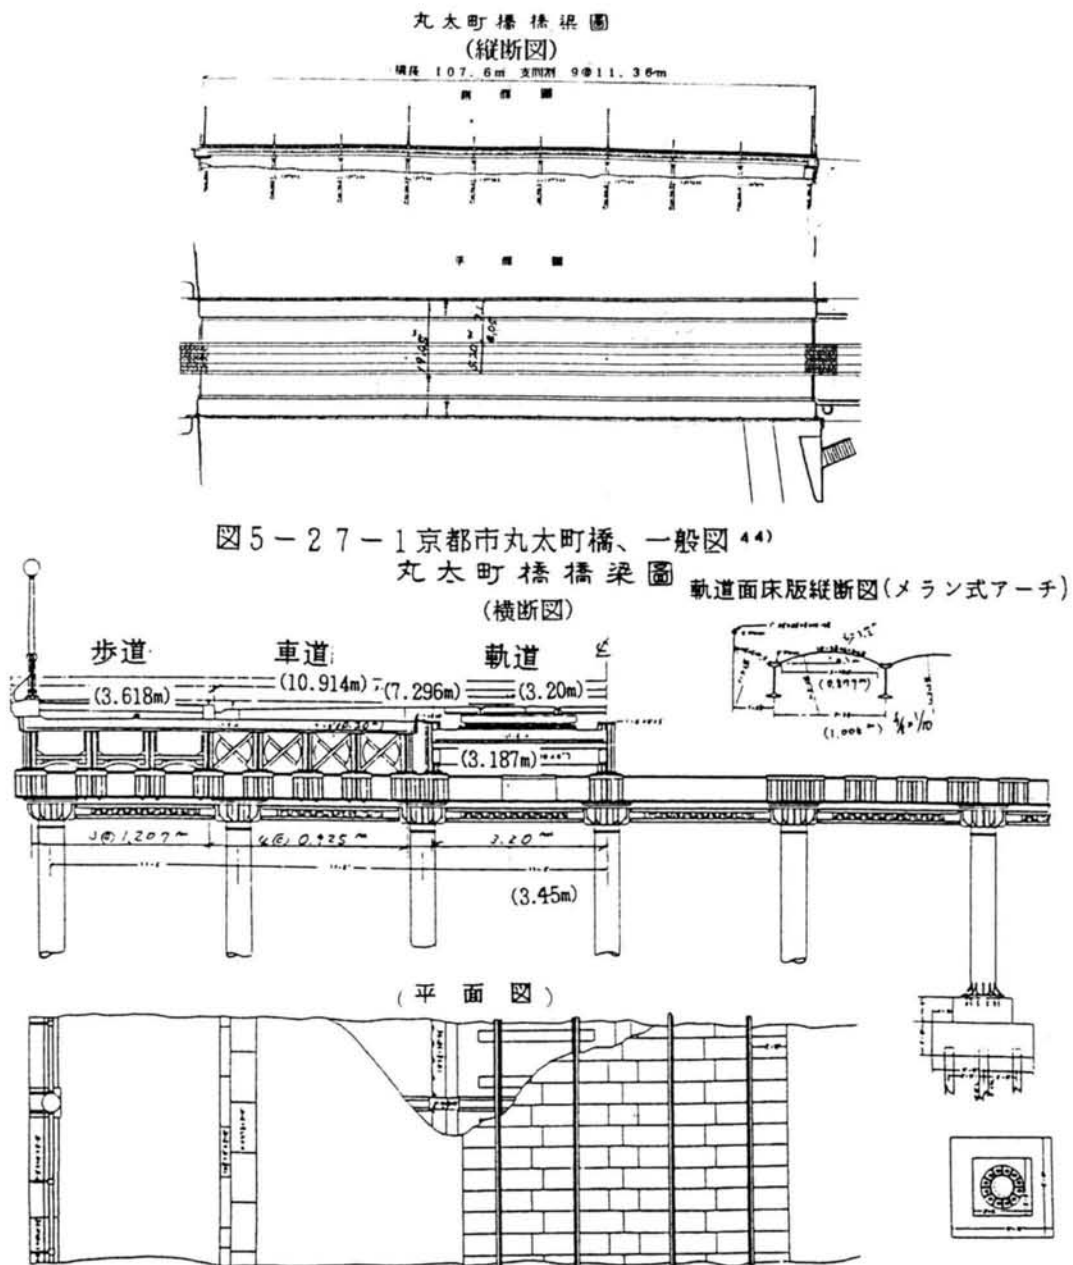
京都市丸太町橋、橋梁横断面図及び平面図<sup>44)</sup>
